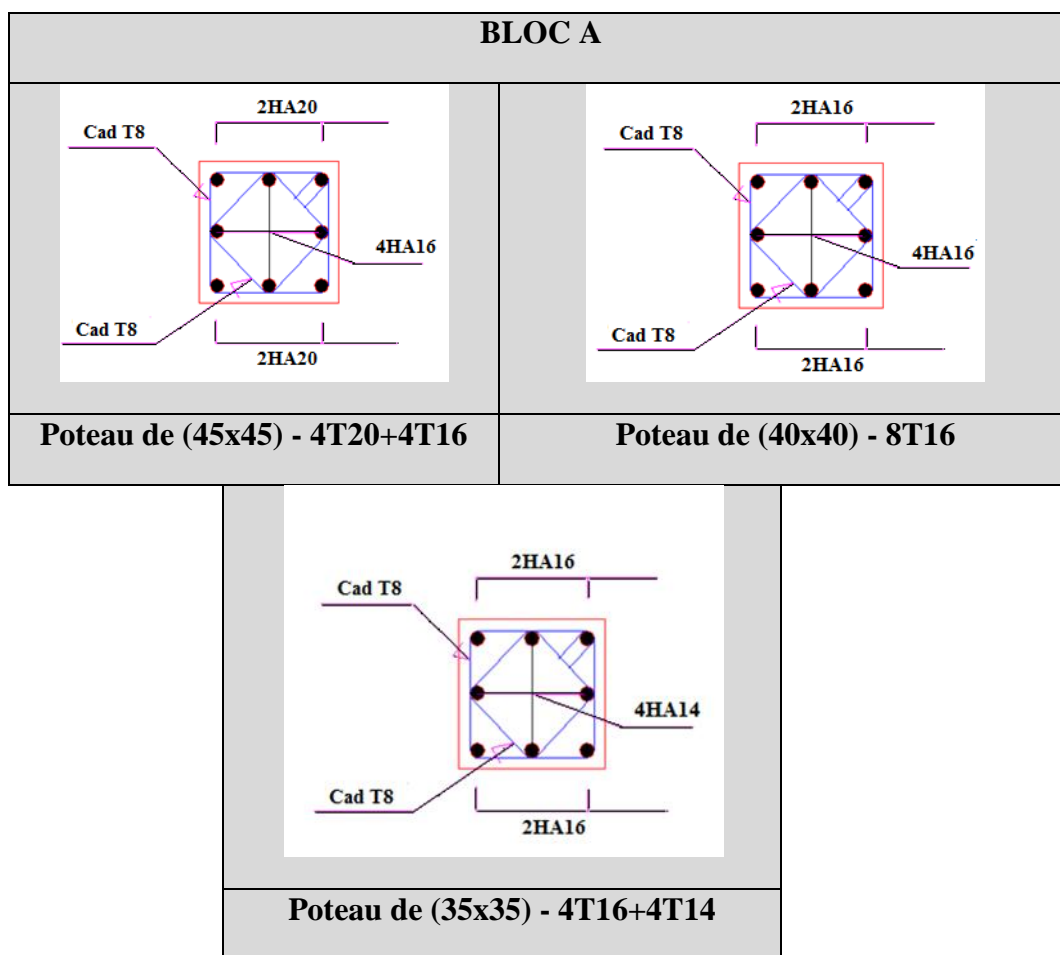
Schéma de ferrailage des poteaux bloc (A)
